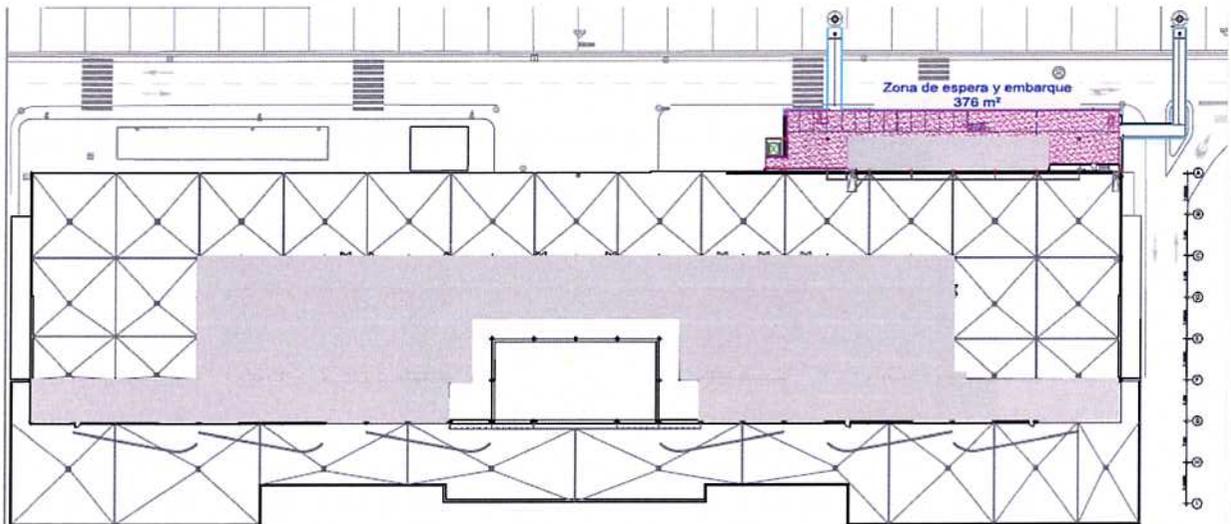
Zonas públicas, privadas y de control del Edificio Terminal. Planta primera (2006)
